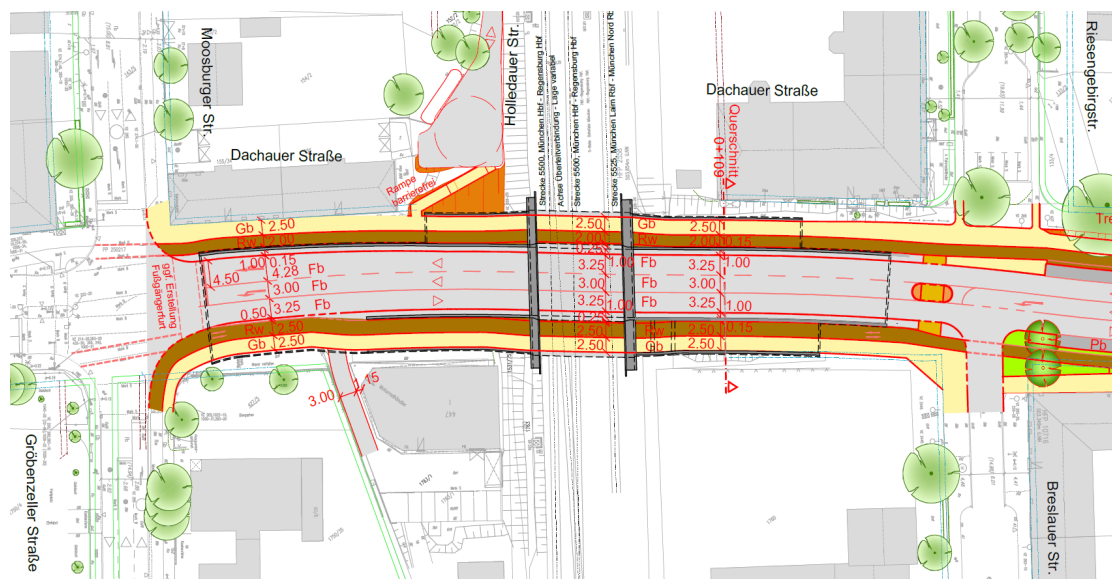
Lageplan Variante 3,70 m lichte Höhe
